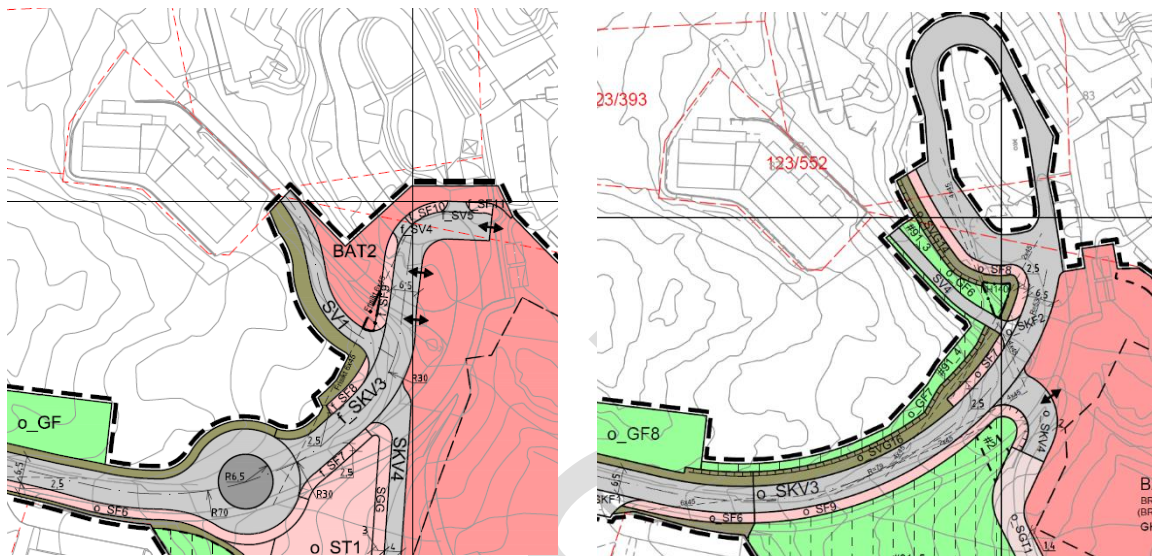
Utsnitt av illustrasjonsplan. Bygget som lå til grunn for planforslaget ved offentlig ettersyn til venstre, bygget som nå ligger til grunn for planforslaget til høyre
